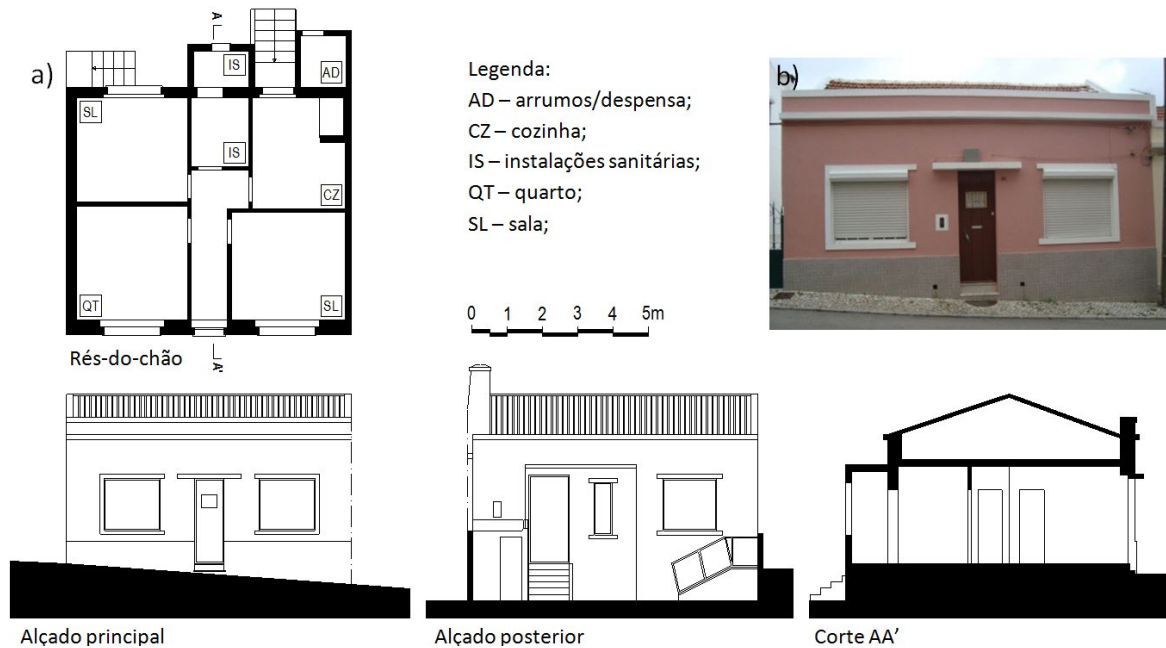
Edifício térreo do Bairro Novo: a) levantamento geométrico; b) vista exterior.
